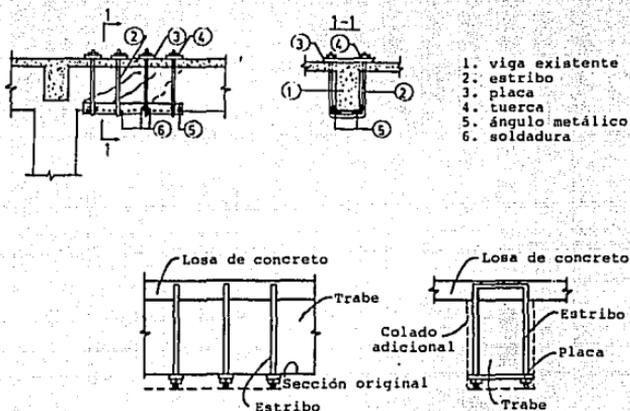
Refuerzo de vigas con estribos postensados.
